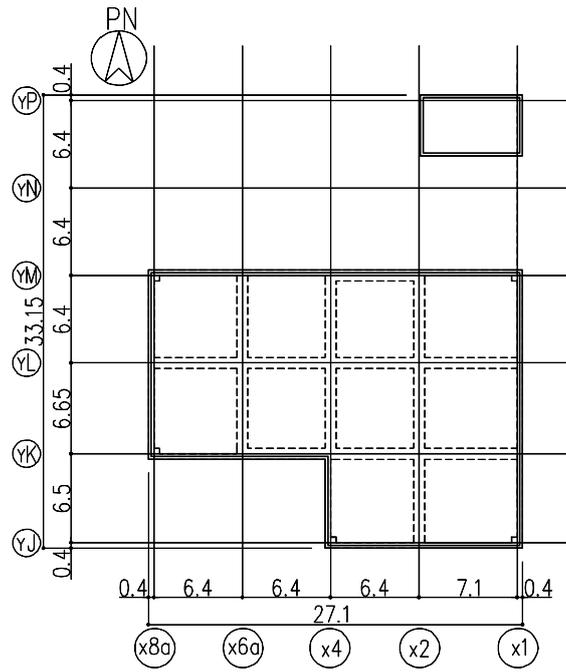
屋上階平面図 (G. L. +15.4) (单位: m)
